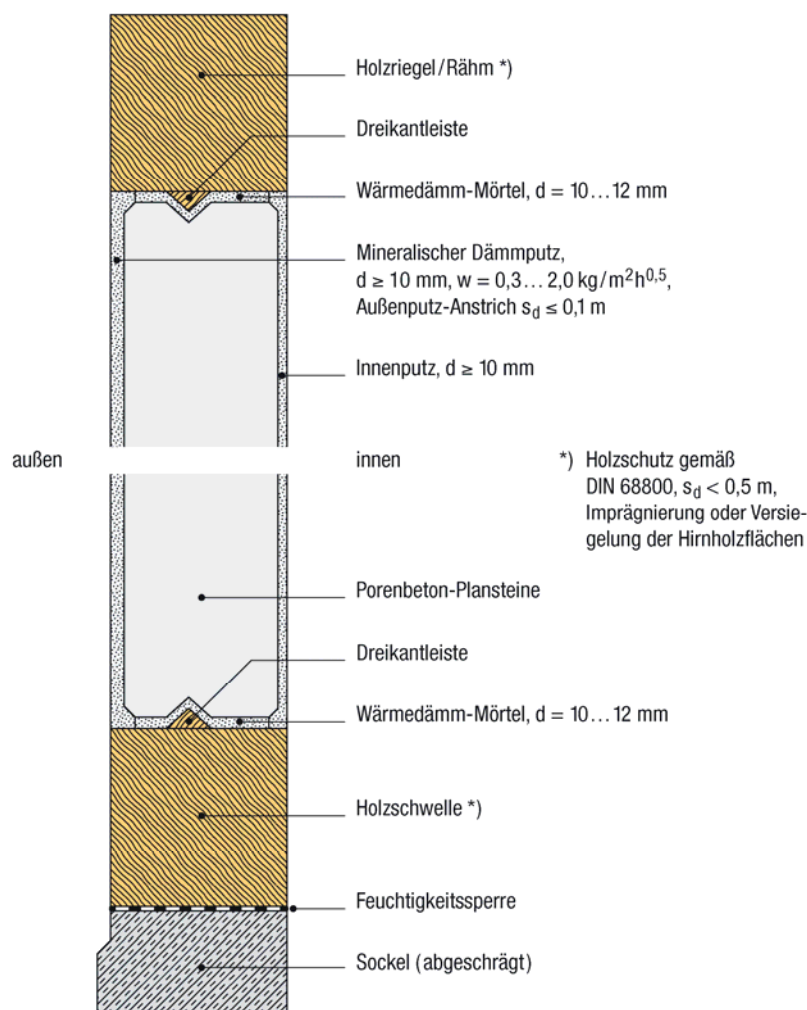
Ausfachung von Fachwerk mit Porenbeton-Plansteinen oder Planbauplatten
